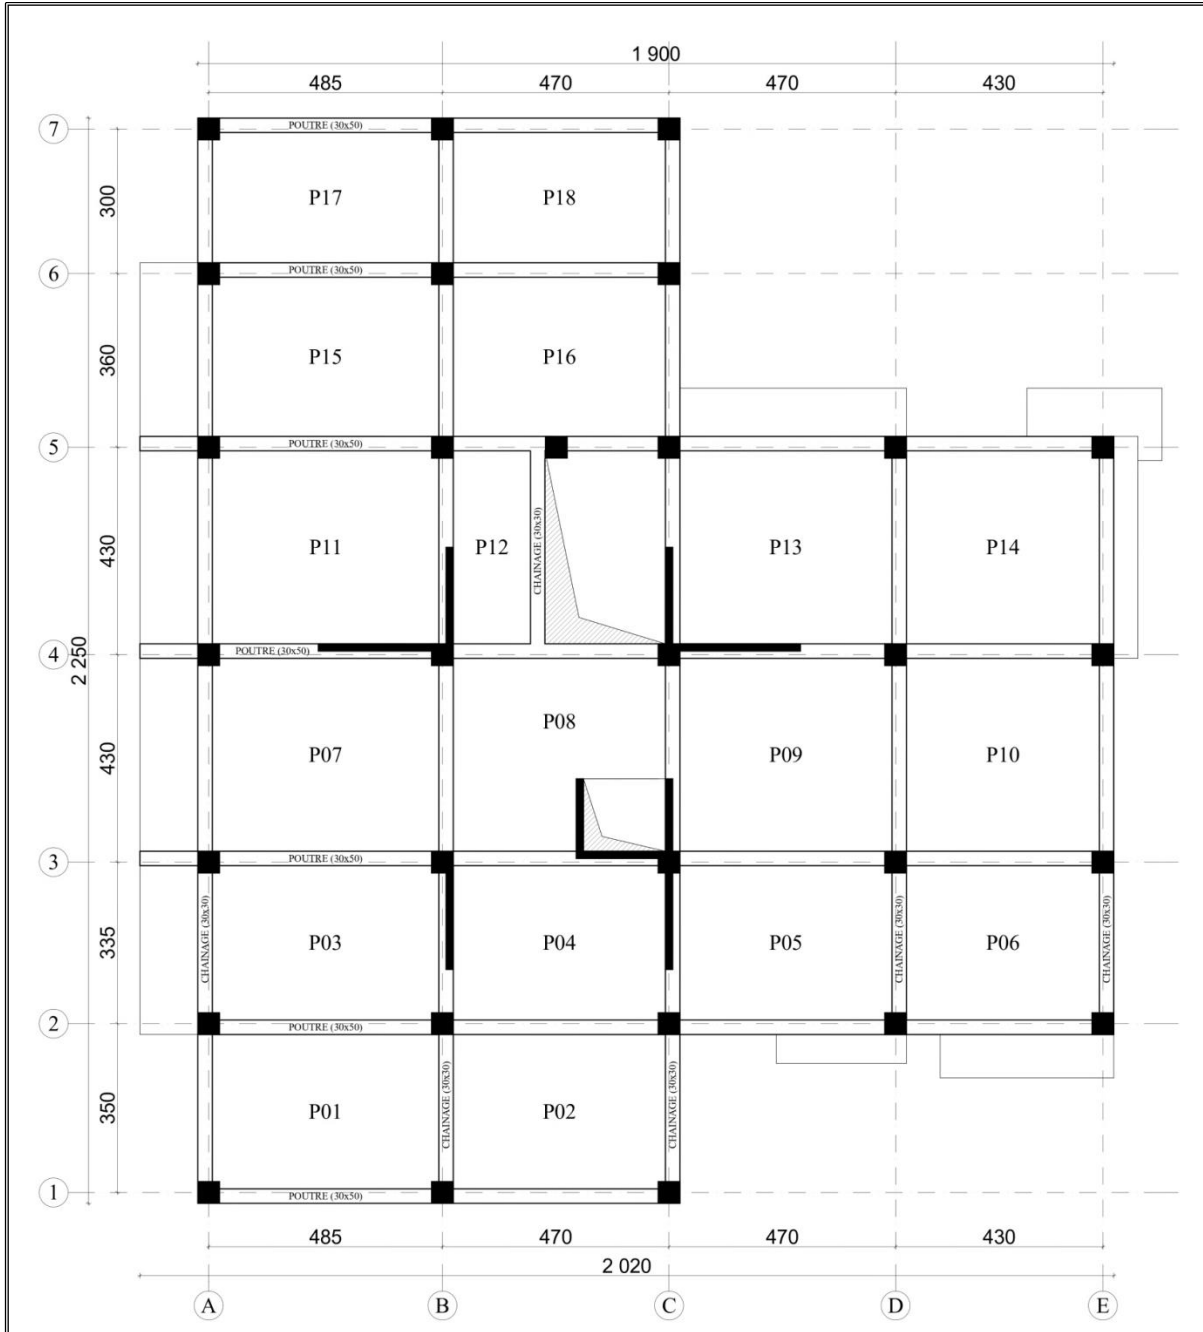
Plan de coffrage du plancher d'étage courant.
